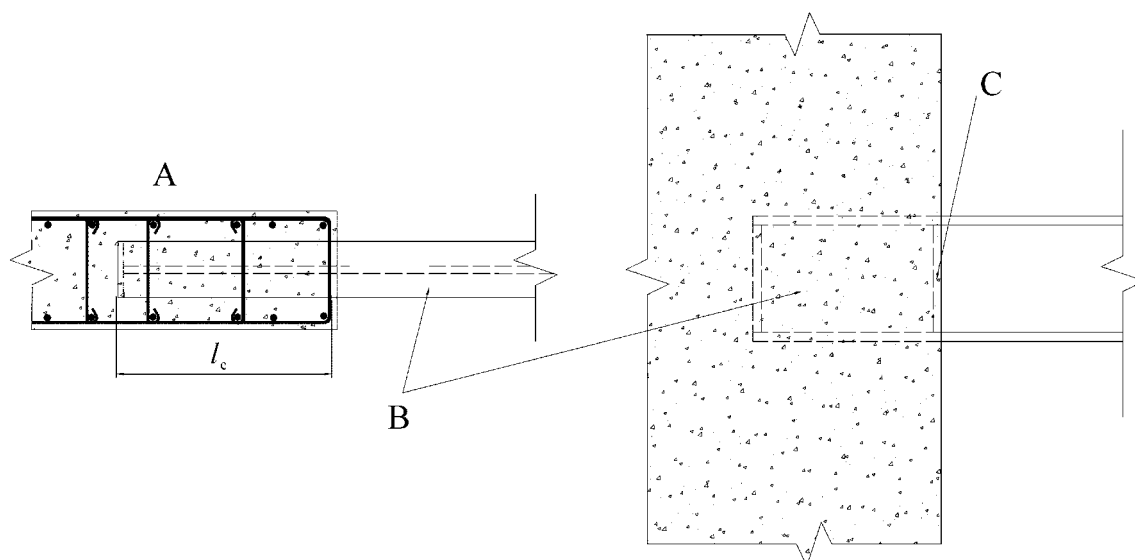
Detalles constructivos de elementos de contorno mixtos parcialmente embebidos (los detalles constructivos de armaduras transversales son para la clase de ductilidad DCH)
